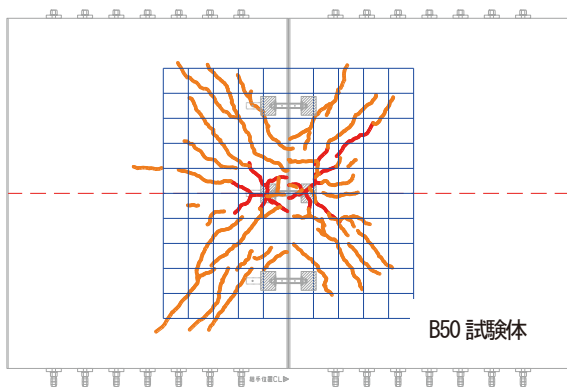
497kN 静的荷重終了後のひび割れ状況
